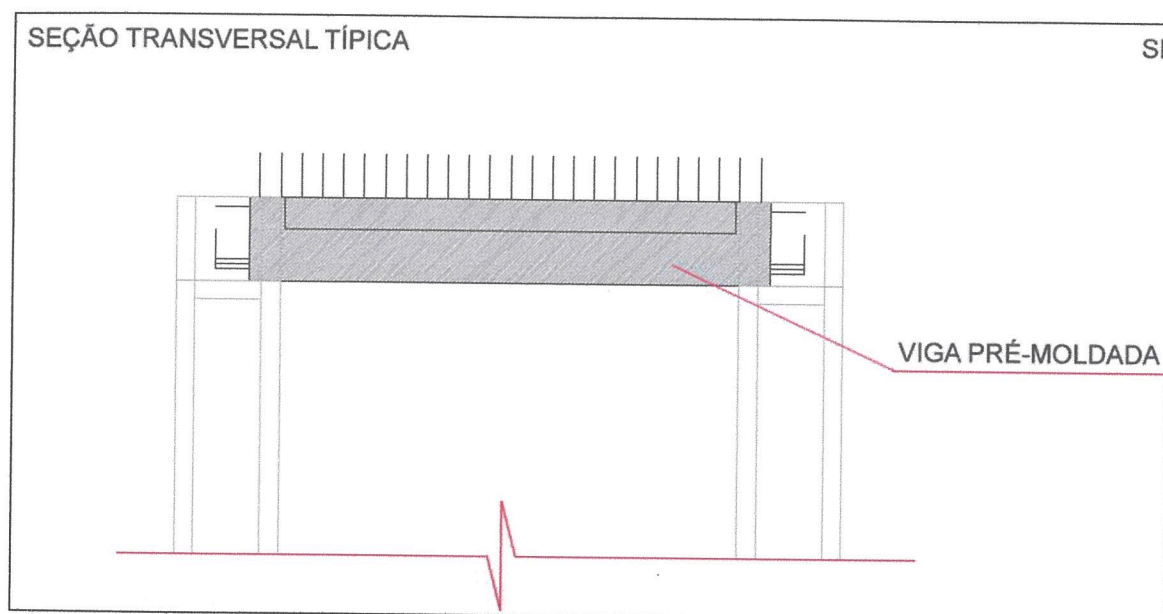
Posicionamento das Vigas Pré-moldadas.
